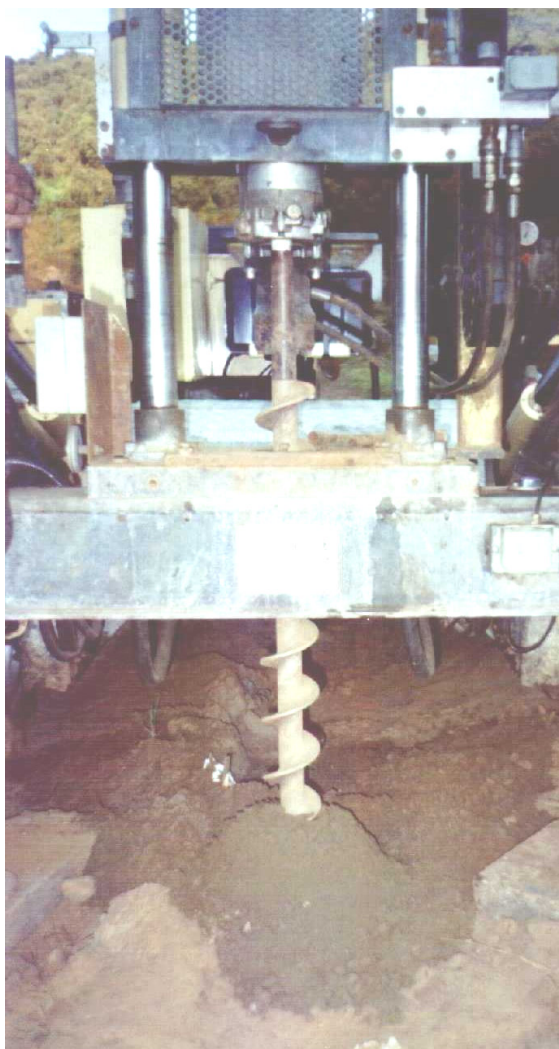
Execução do pré-furo na bermas de alteamento da Barragem de Gongo Soco
